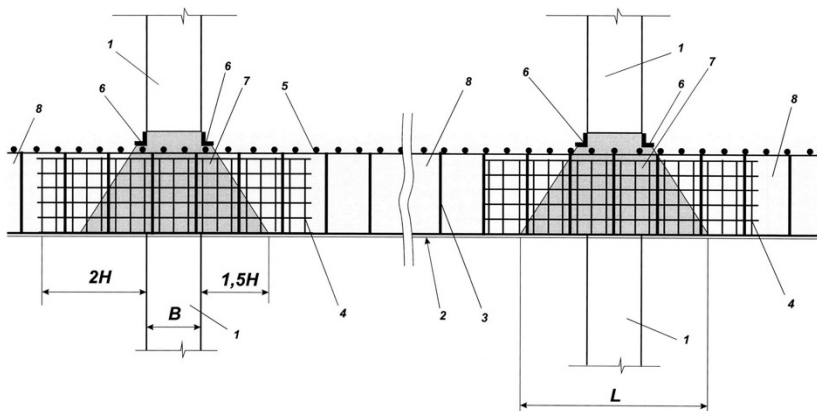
Сечение 1-1 на фиг. 1: фрагмент размещения собранной несъемной опалубки с арматурными каркасами и сетками на несущих стенах [4], где: 1 – несущие стены, 2 – универсальные модульные элементы, 3 – несущий арматурный каркас, 4 – несущая вертикальная арматурная сетка, 5 – верхняя горизонтальная сетка, 6 – шаблон, 7 – тяжёлый бетон, 8 – легкий бетон.
